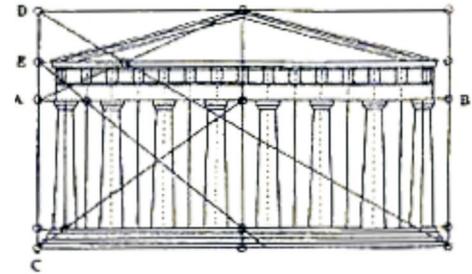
EL PARTENÓN, ICTINO Y CALÍCRADES, 447-432 A.C., ATENAS, GRECIA. ALZADO FRONTAL.
